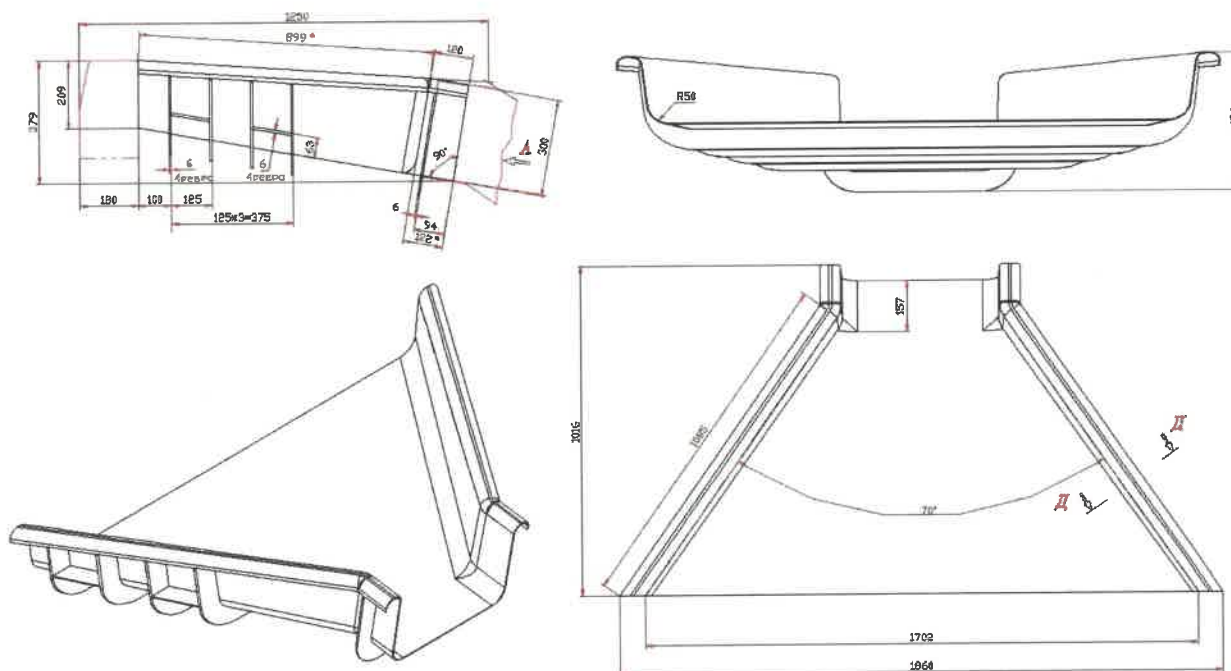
ВД-005.2-2 (ВД-005.2-3) Быстроток верхний двухсторонний прямой 300х500 мм для обочины 1,25 м. Масса – 13 кг.
